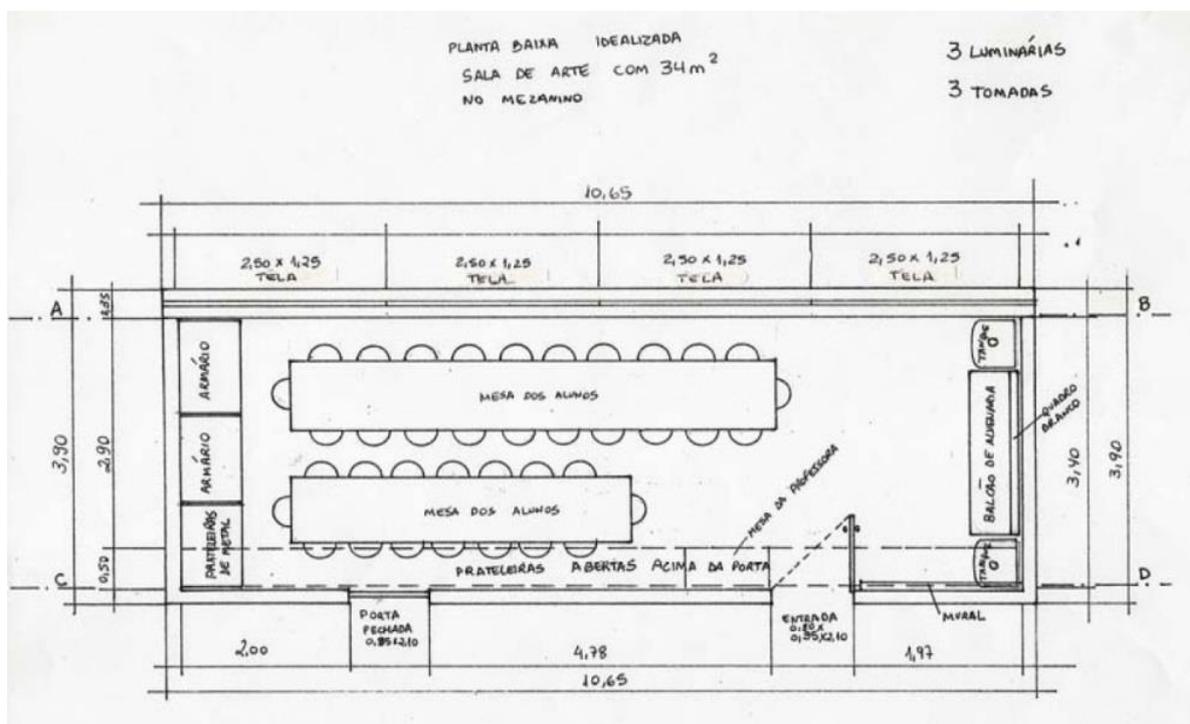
Planta baixa do MeZanino idealizado a sala de Arte (KRAUZE, 2009).
